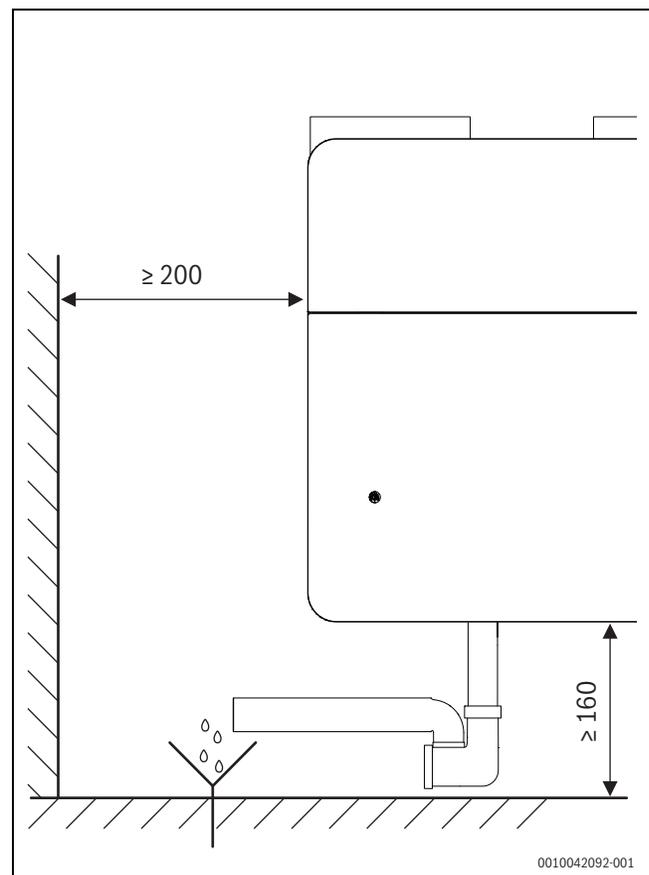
Mindestabstände HRV176... mit Siphon HRV-BS
